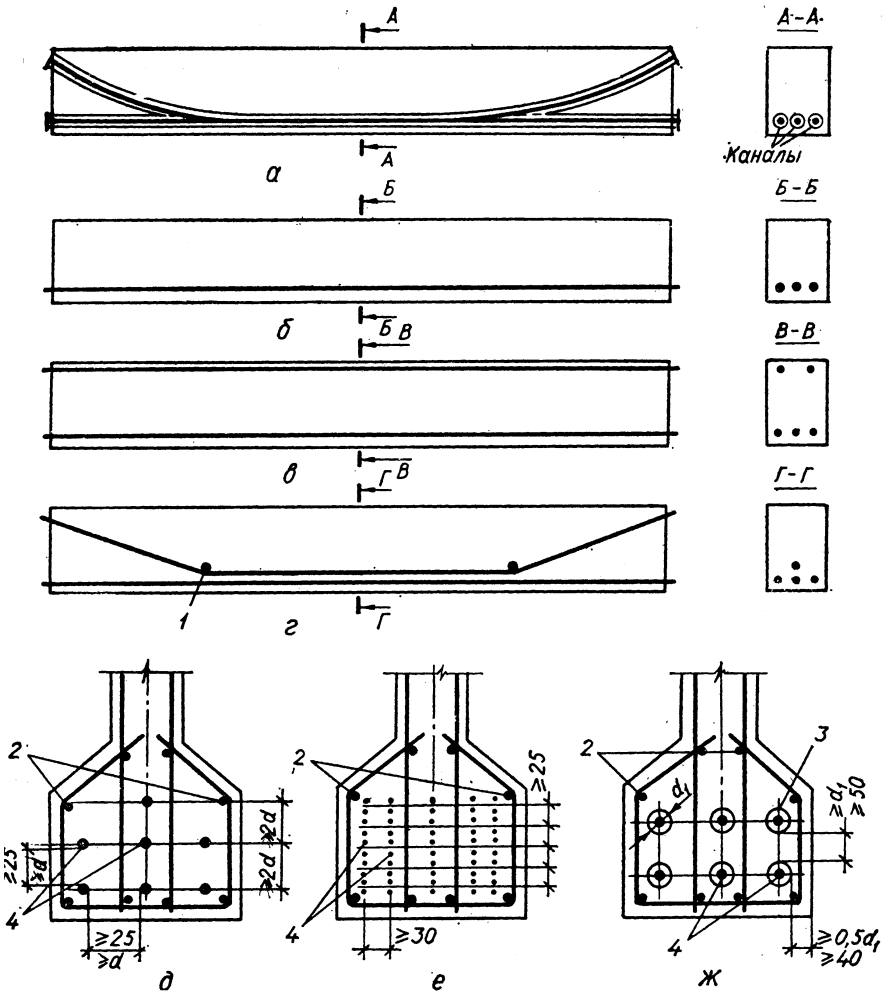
Армування поперечно напружених балок напруженою арматурою: *а* – у разі натягування на бетон; *б* – у разі натягування на упори одиночної арматури; *в* – те саме, подвійної; *г* – те саме, з відгином частини арматури біля опор; *д* – розташування арматури в розтягнутій зоні перерізу в разі армування поперечно напруженого елемента стержнями періодичного профілю або канатами; *е* – те саме, дротом; *ж* – те саме, пучками або стержнями при розташуванні арматури в каналах; 1 – обвідний пристрій; 2 – ненапружена арматура; 3 – канали; 4 – поперечно напружена арматура
